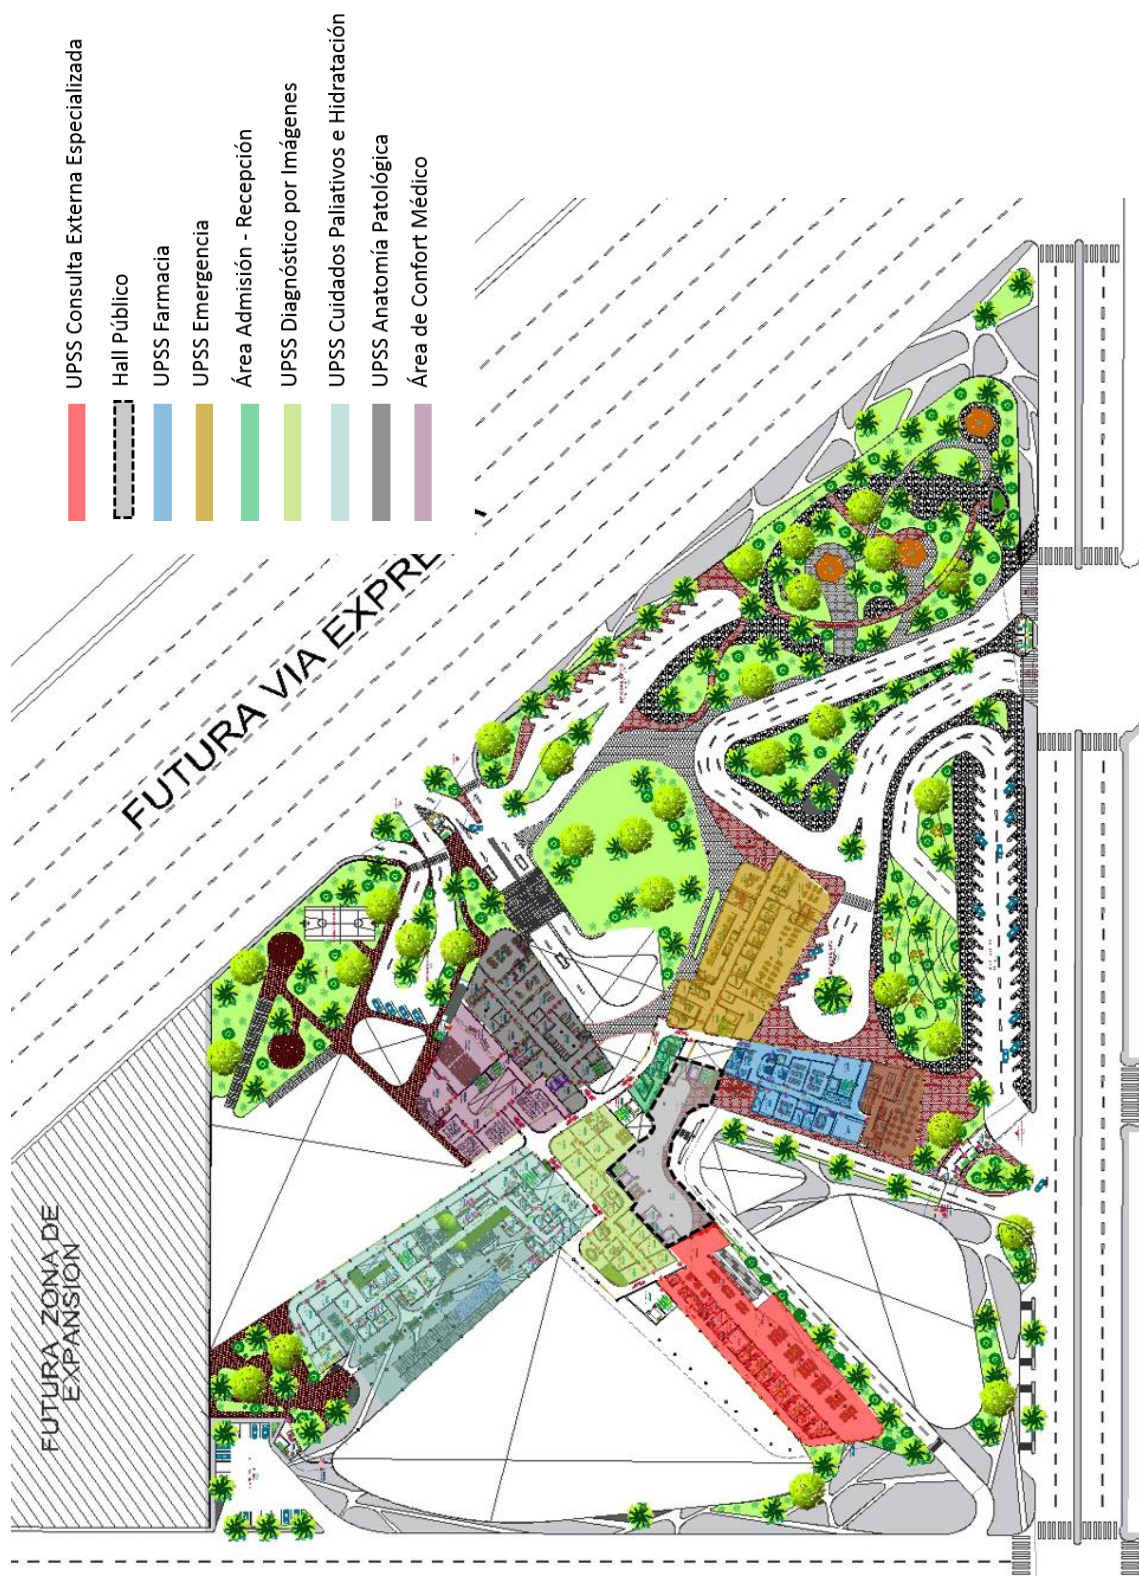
Zonificación Primera Planta de la Propuesta Arquitectónica.
